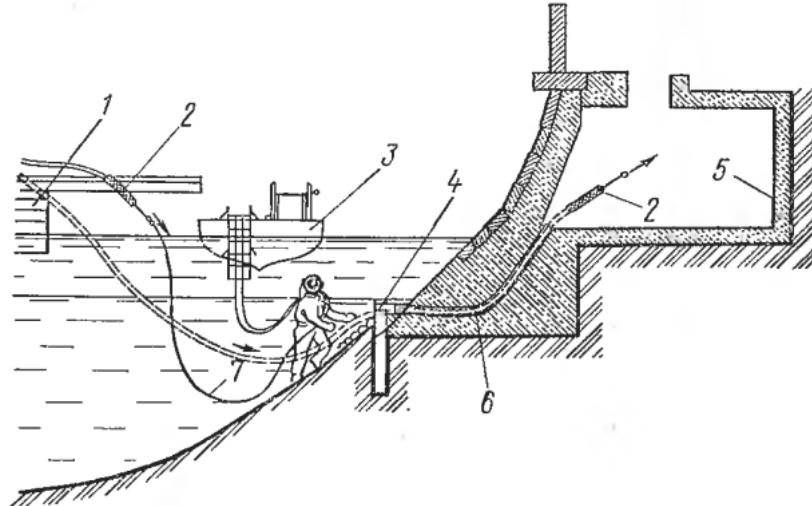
Прокладка кабеля под водой и ввод его в береговой колодец:
